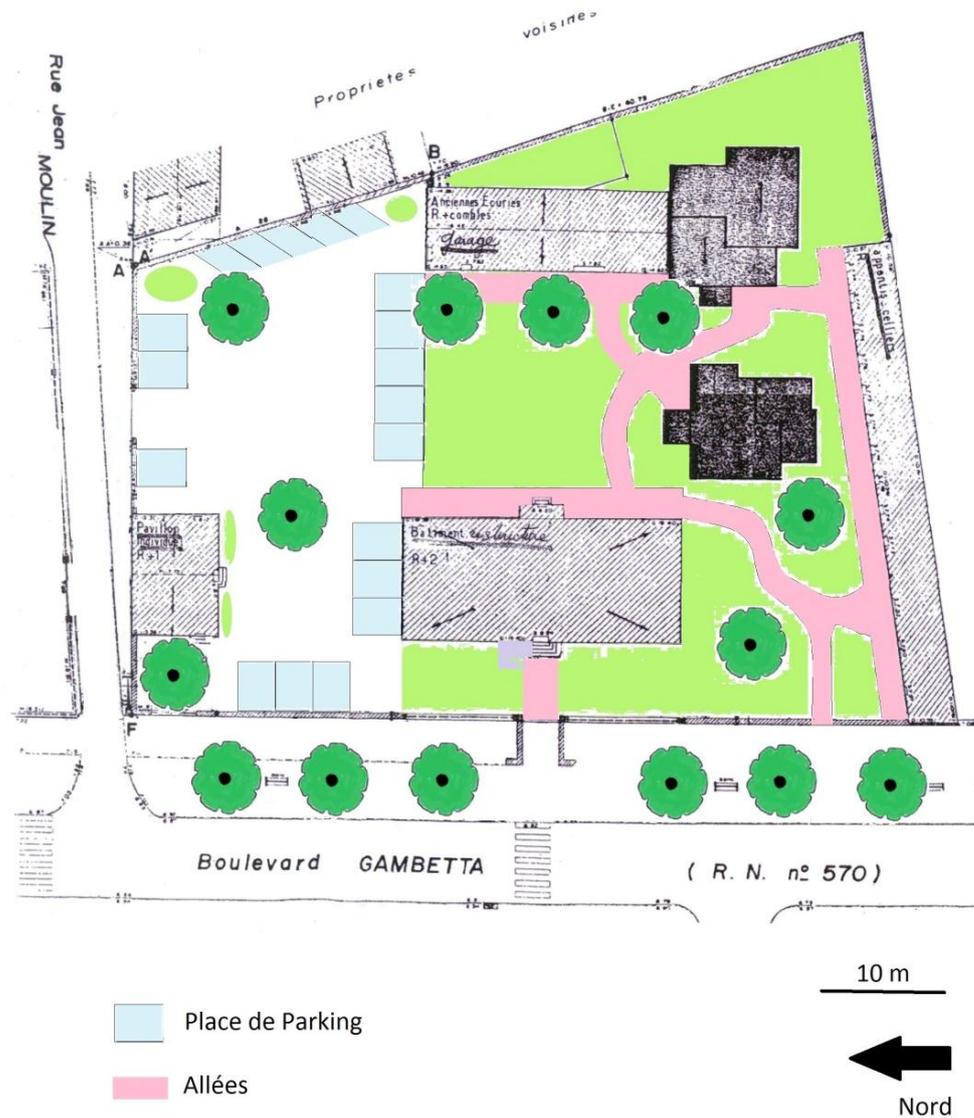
Plan Masse de l'aménagement de la Gendarmerie - Source: Conseil Général - Réalisation: K.McCarron
